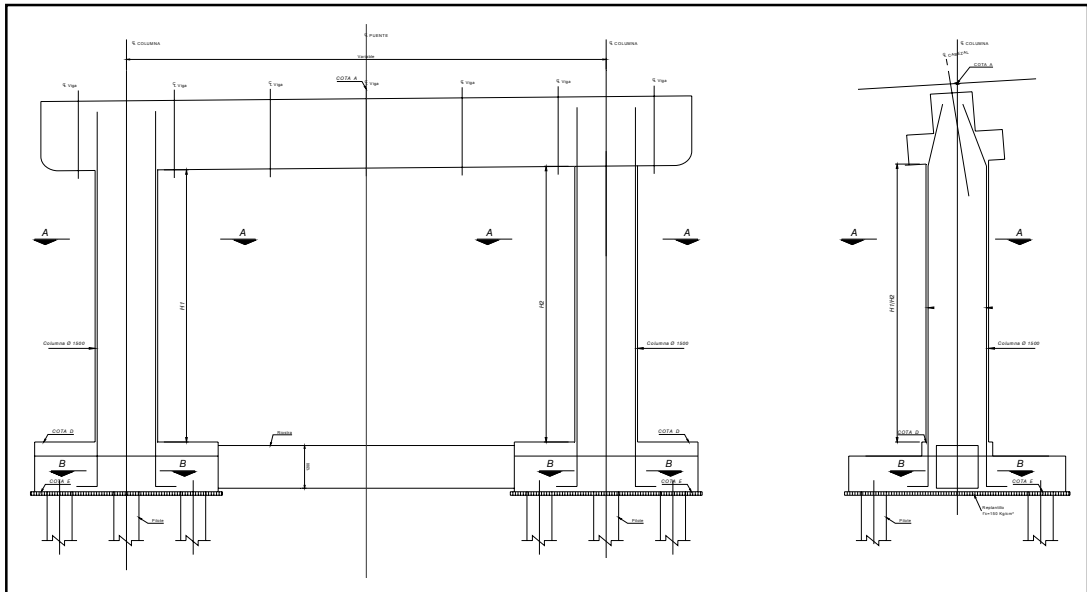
Subestructura del Puente Tipo (Pórtico 1).
